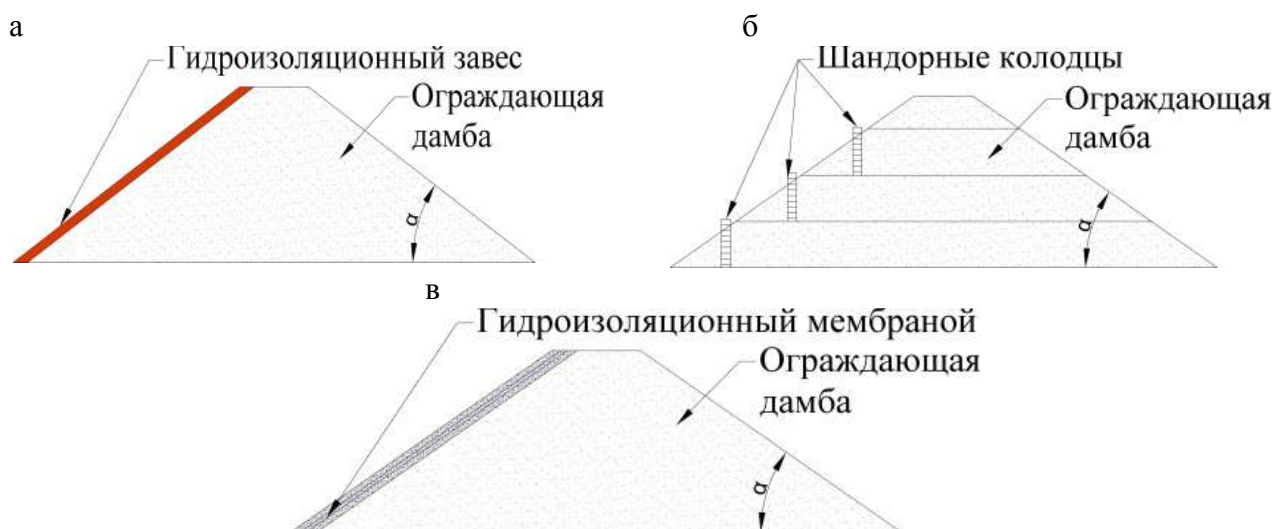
Схемы гидроизоляционных экранов ограждающих дамб:
